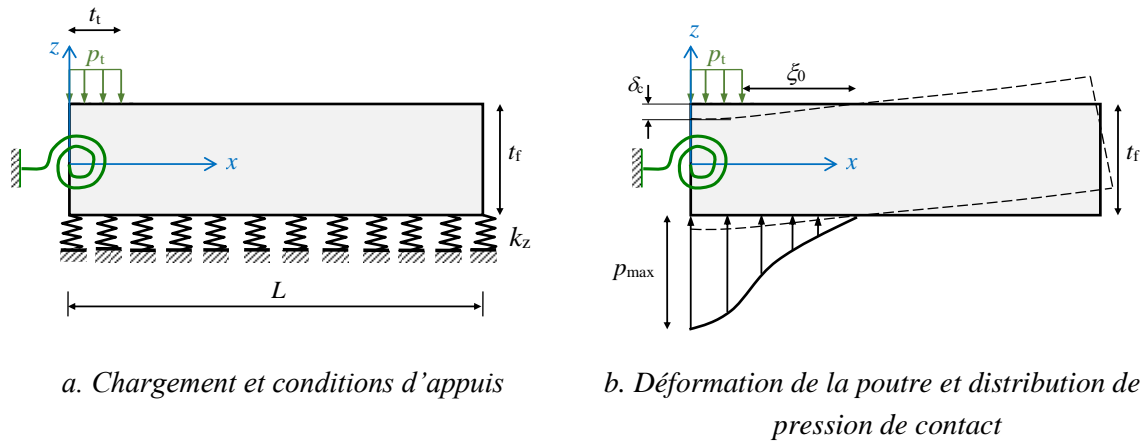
Poutre avec ressort flexionnel reposant sur appuis élastiques
